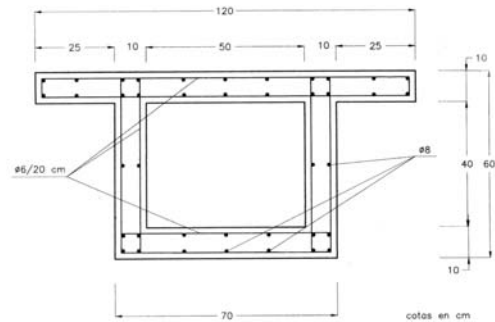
Sección transversal de las vigas de Anlló [ANLLÓ (1996)]
